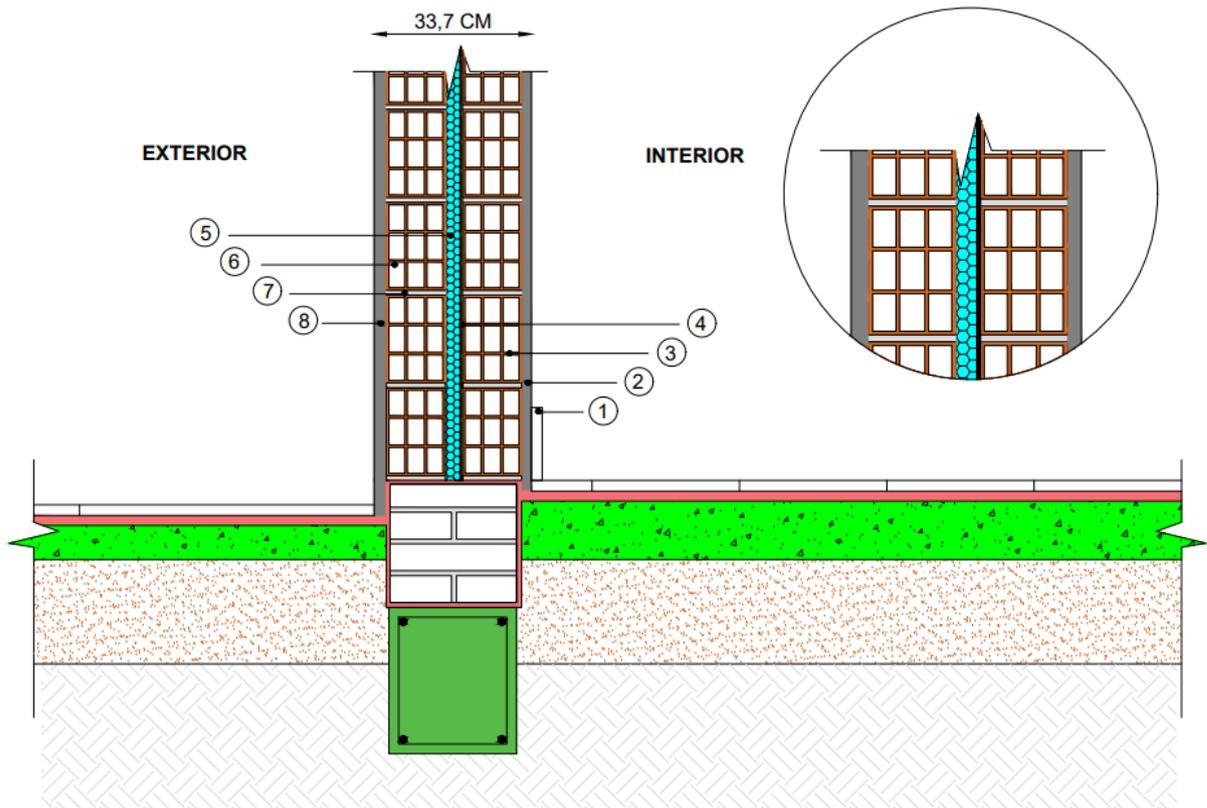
Anteproyecto arquitectónico: detalle del paquete de muro.
